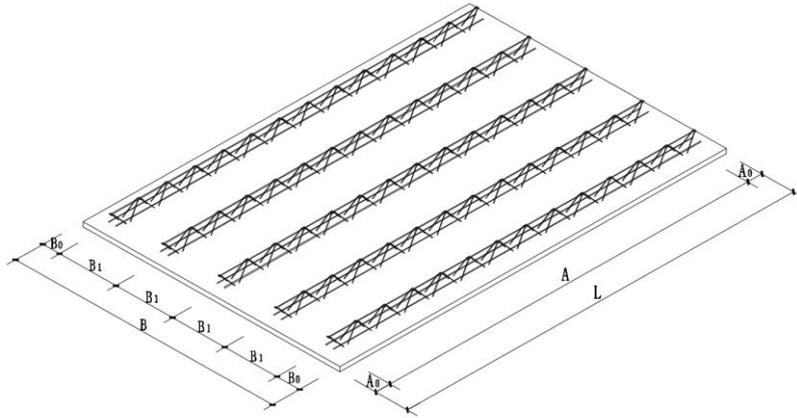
钢筋桁架保温楼承板三维图示
